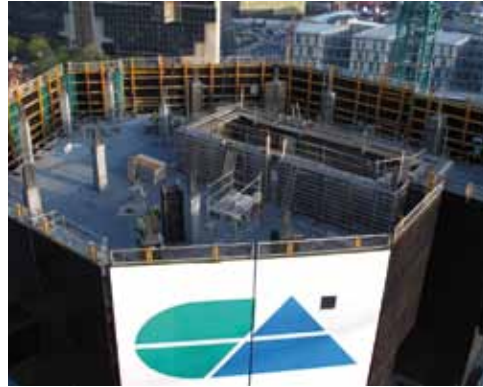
Sistema de protección perimetral para las Torres Garellano en Bilbao. Fig. 16. Detalle de la protección perimetral en las Torres Garellano. Fig. 17. Sistema de protección perimetral en Torre PwC
